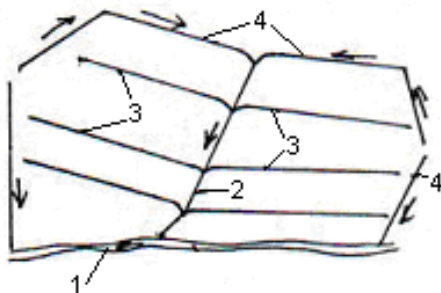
Схема расположения пограничных нагорных каналов: 1 – водоприемник; 2 – магистральный канал; 3 – транспортирующие собиратели; 4 – пограничные нагорные каналы
